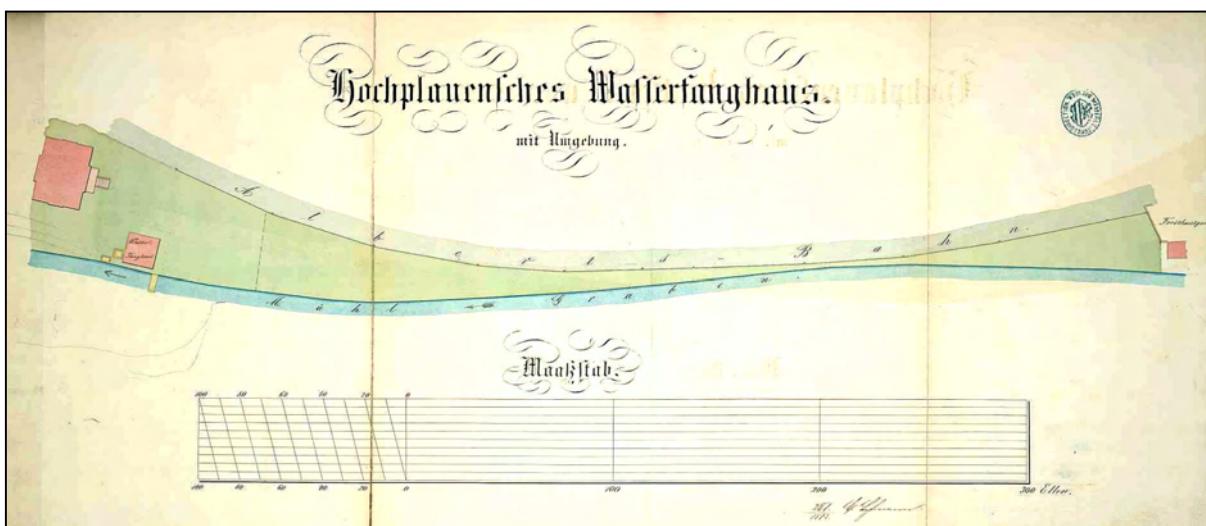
Lageplan des hochplauenschen Wasserhauses 1862
